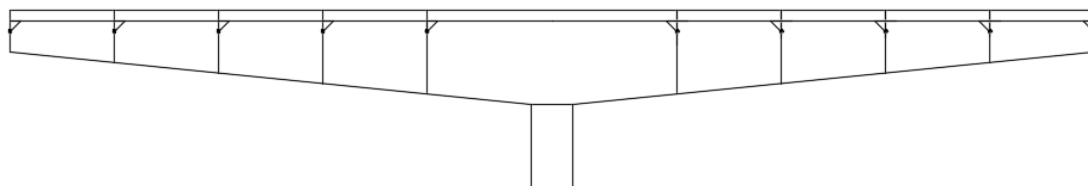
| 6 – Pormenor de aplicação de pré-esforço com o avanço da consola
